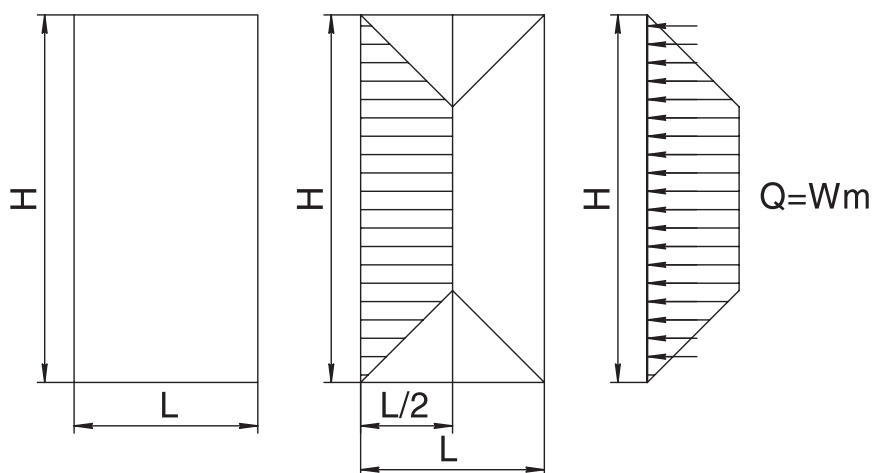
Расчетная схема ветровой нагрузки W_m
